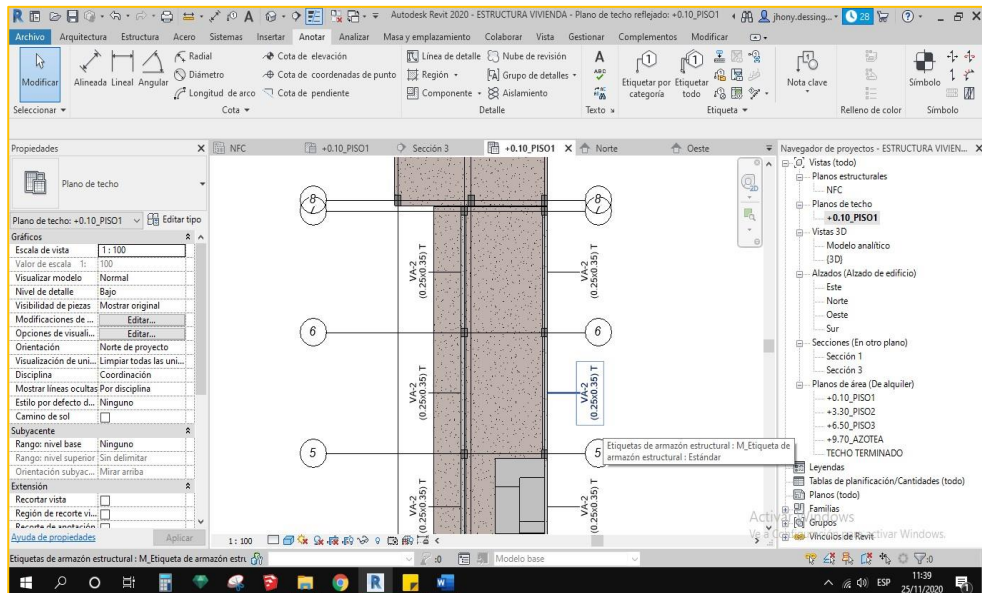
Ubicación en planta de vigas tipo VA-2 (0.25 x 0.35 m).
